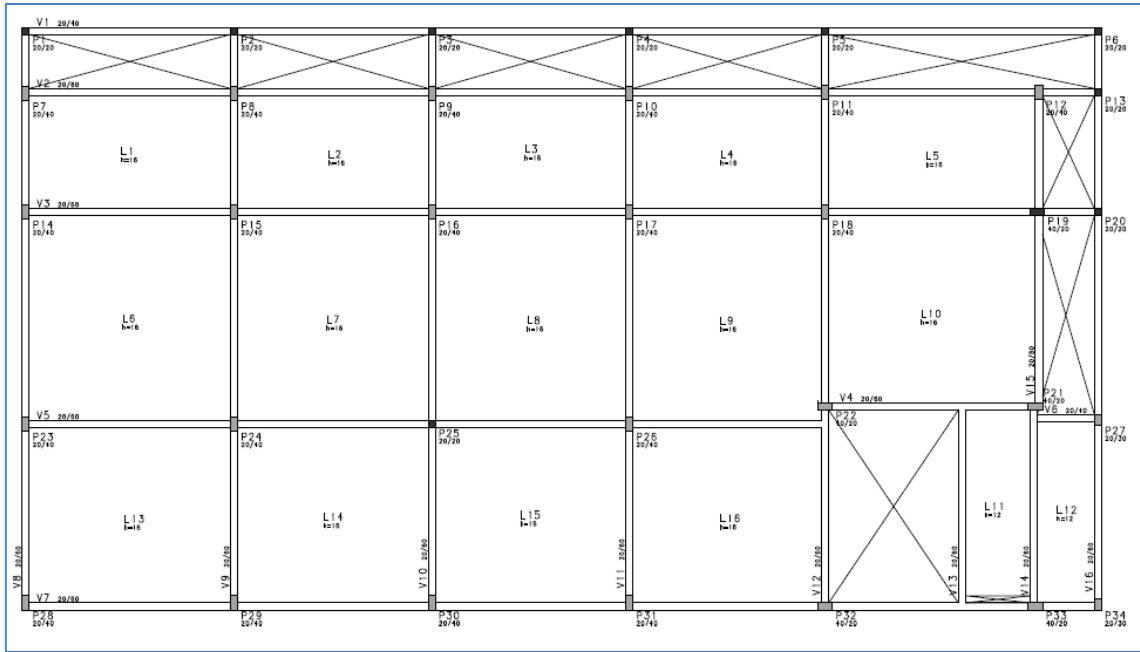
Planta de fôrma: subsolo, concreto armado (CAD/TQS)
